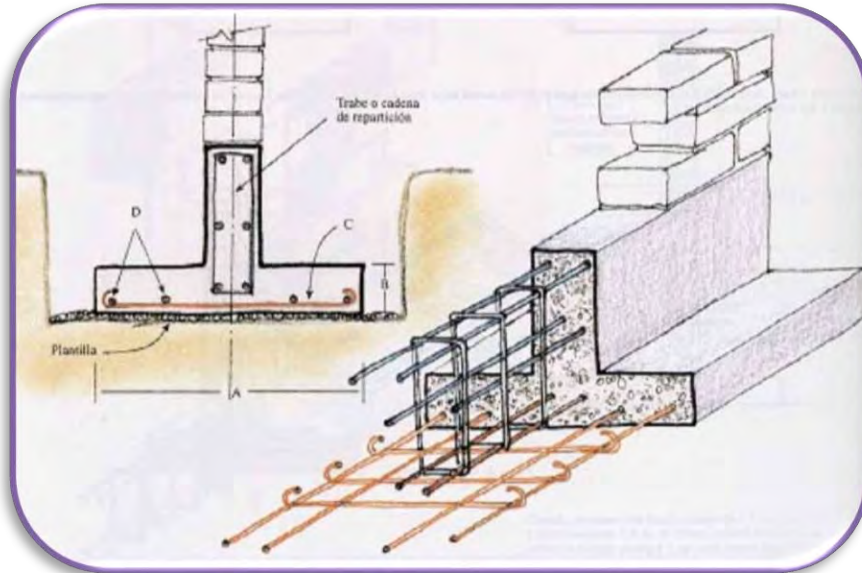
detalle de Zapata Corrida <http://www.elconstructorcivil.com/2012/05/zapatas-corridas-de-concreto-armado.html>
